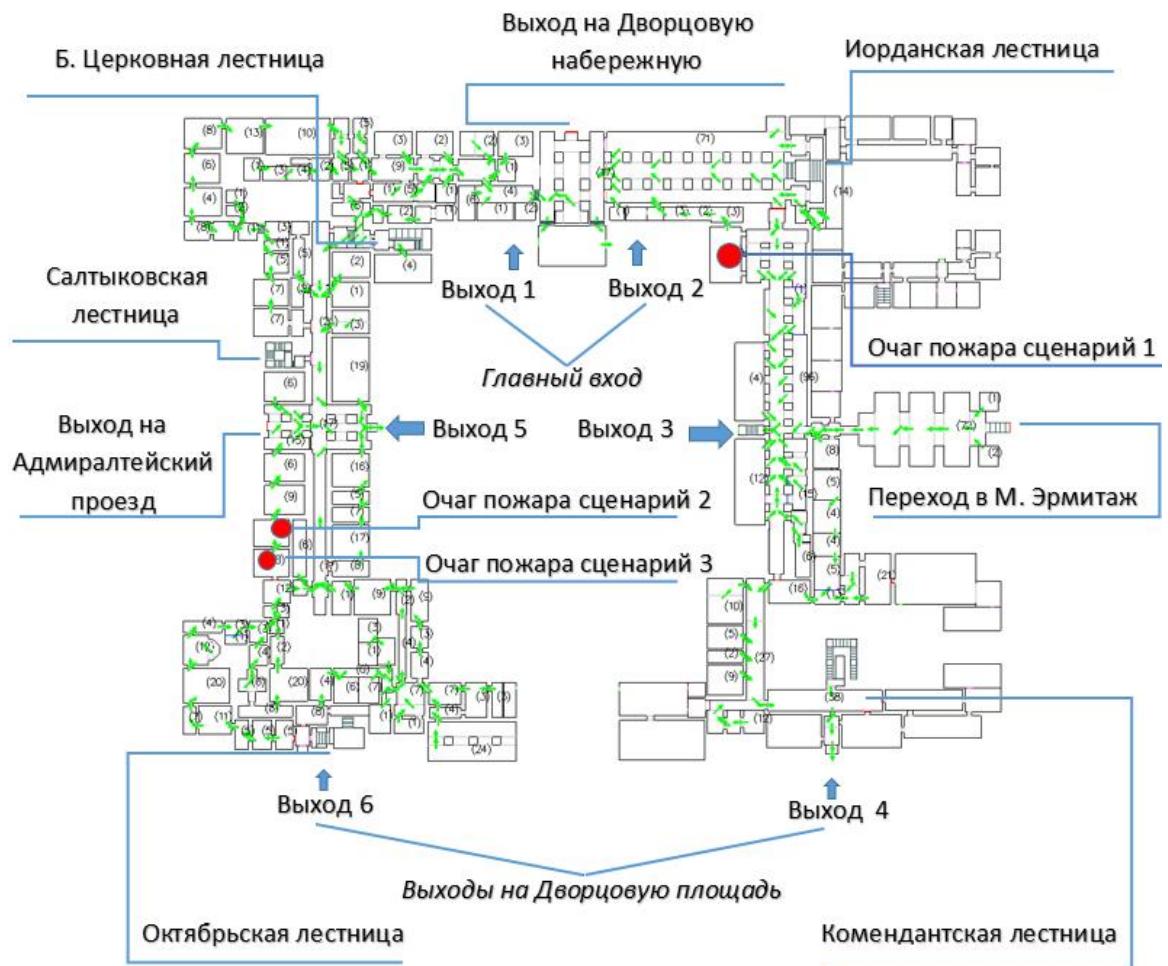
Эвакуационные лестницы и выходы на плане первого этажа Зимнего дворца
